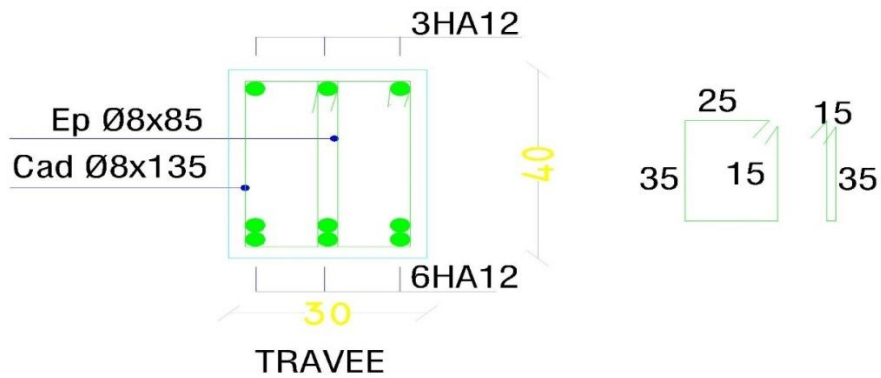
Ferrailage de la poutre principale (RDC et EC), en travée
